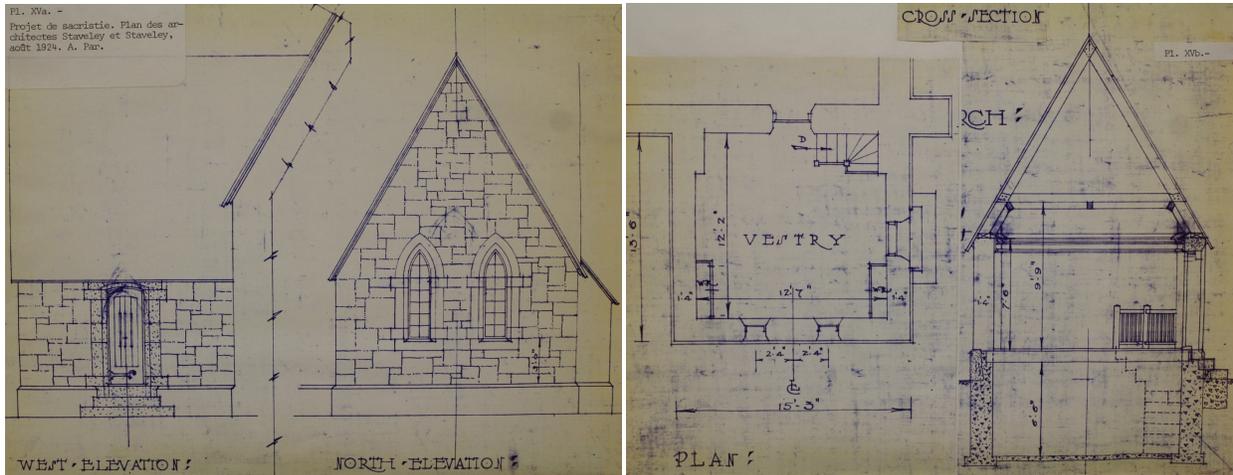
Plan et élévation de la nouvelle sacristie en 1928
